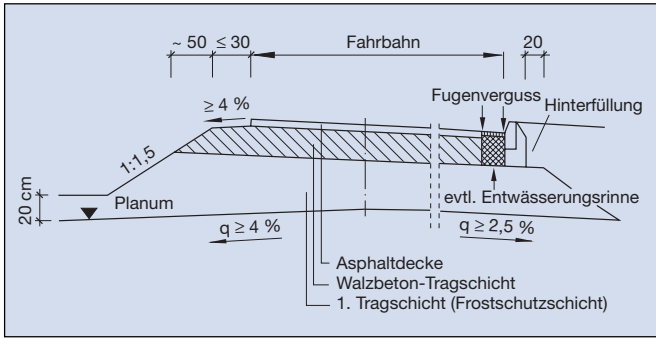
Randausbildungen für eine Walzbeton-Tragschicht
